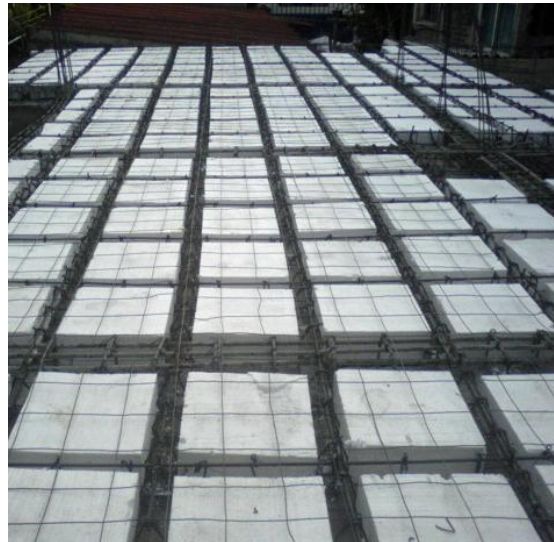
Detalle constructivo de losa nervada mostrando viguetas, nervios y capa de compresión.
